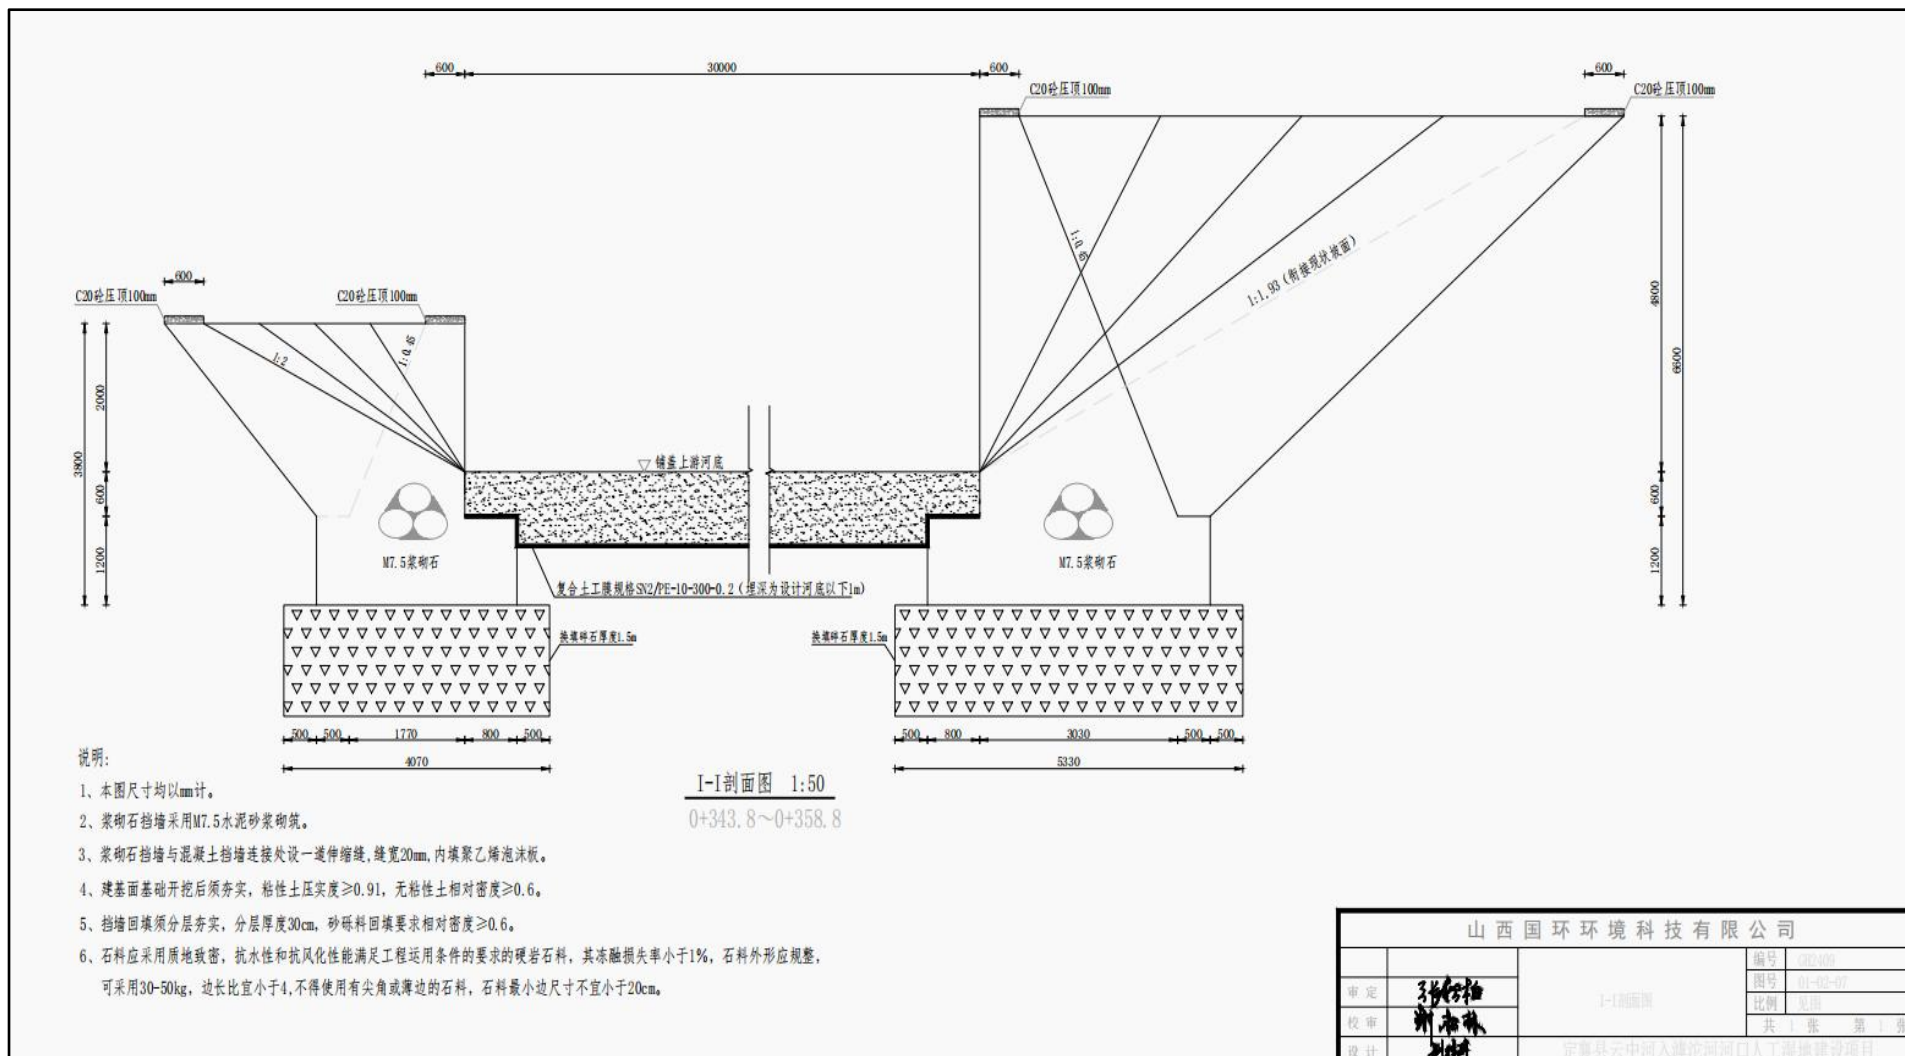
气盾坝 I-I 剖面图 (1:50)
